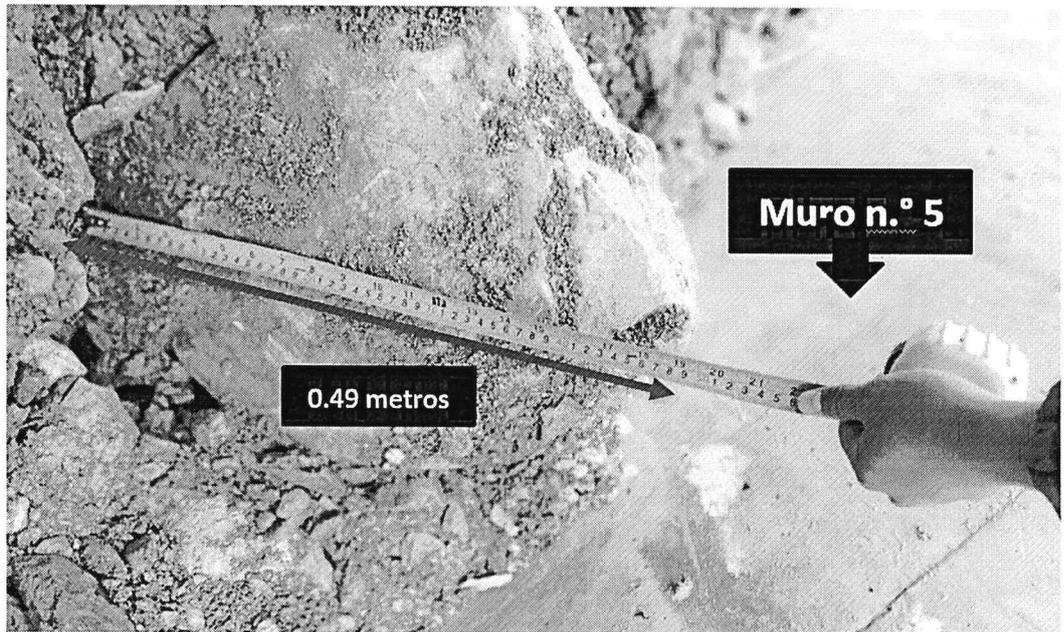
Se evidenció piedra de 0.49 de largo, detrás del muro de concreto armado n.º 5.
